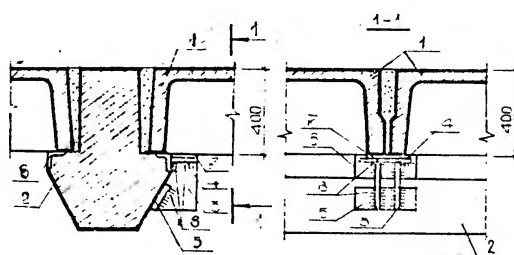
Подведение столиков на сварке с закладными деталями
